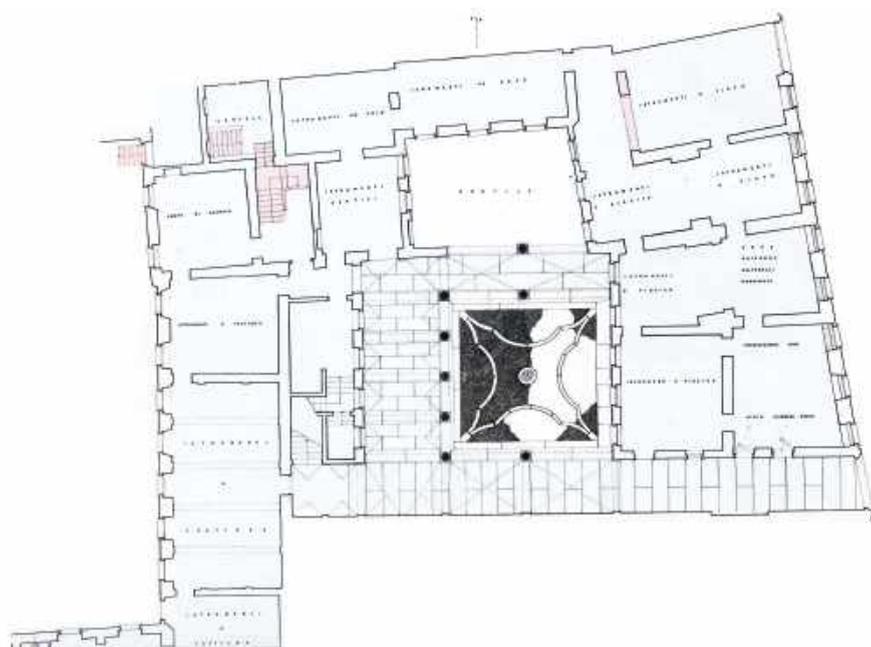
Pianta piano terra, progetto di restauro (rielaborazione)
